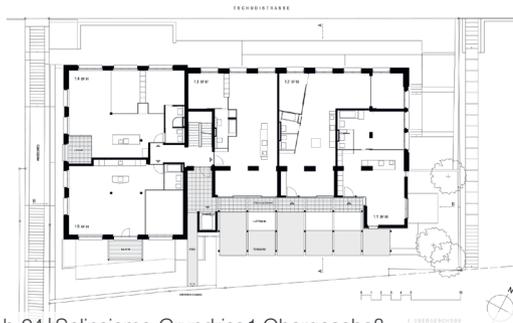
| Solinsieme. Grundriss 1. Obergeschoß
